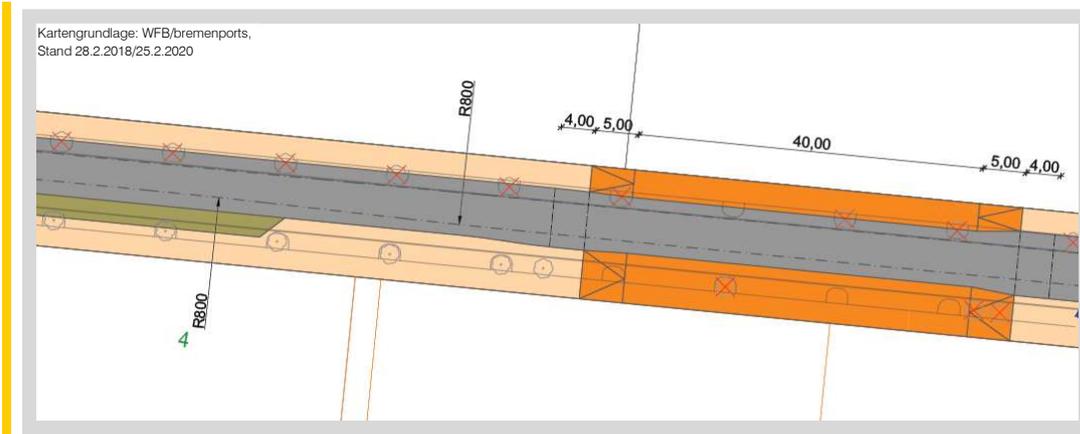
Ausschnitt Lageplan Haltestelle Nähe Überseepark
